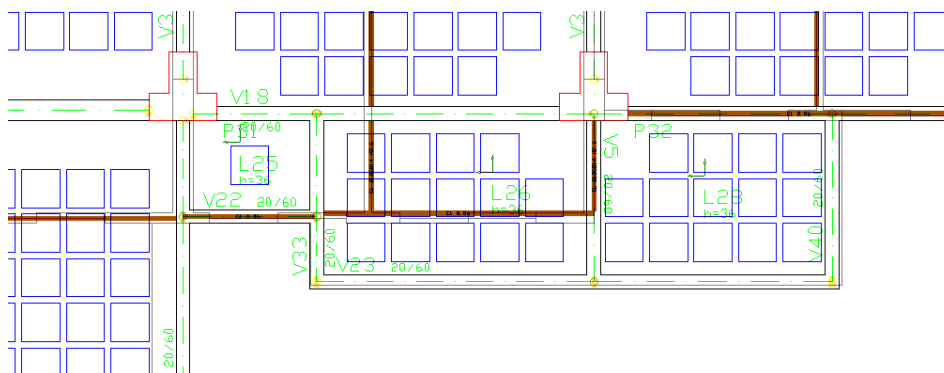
Pavimento PT1, da Solução com Laje Nervurada, com nova viga em balanço
